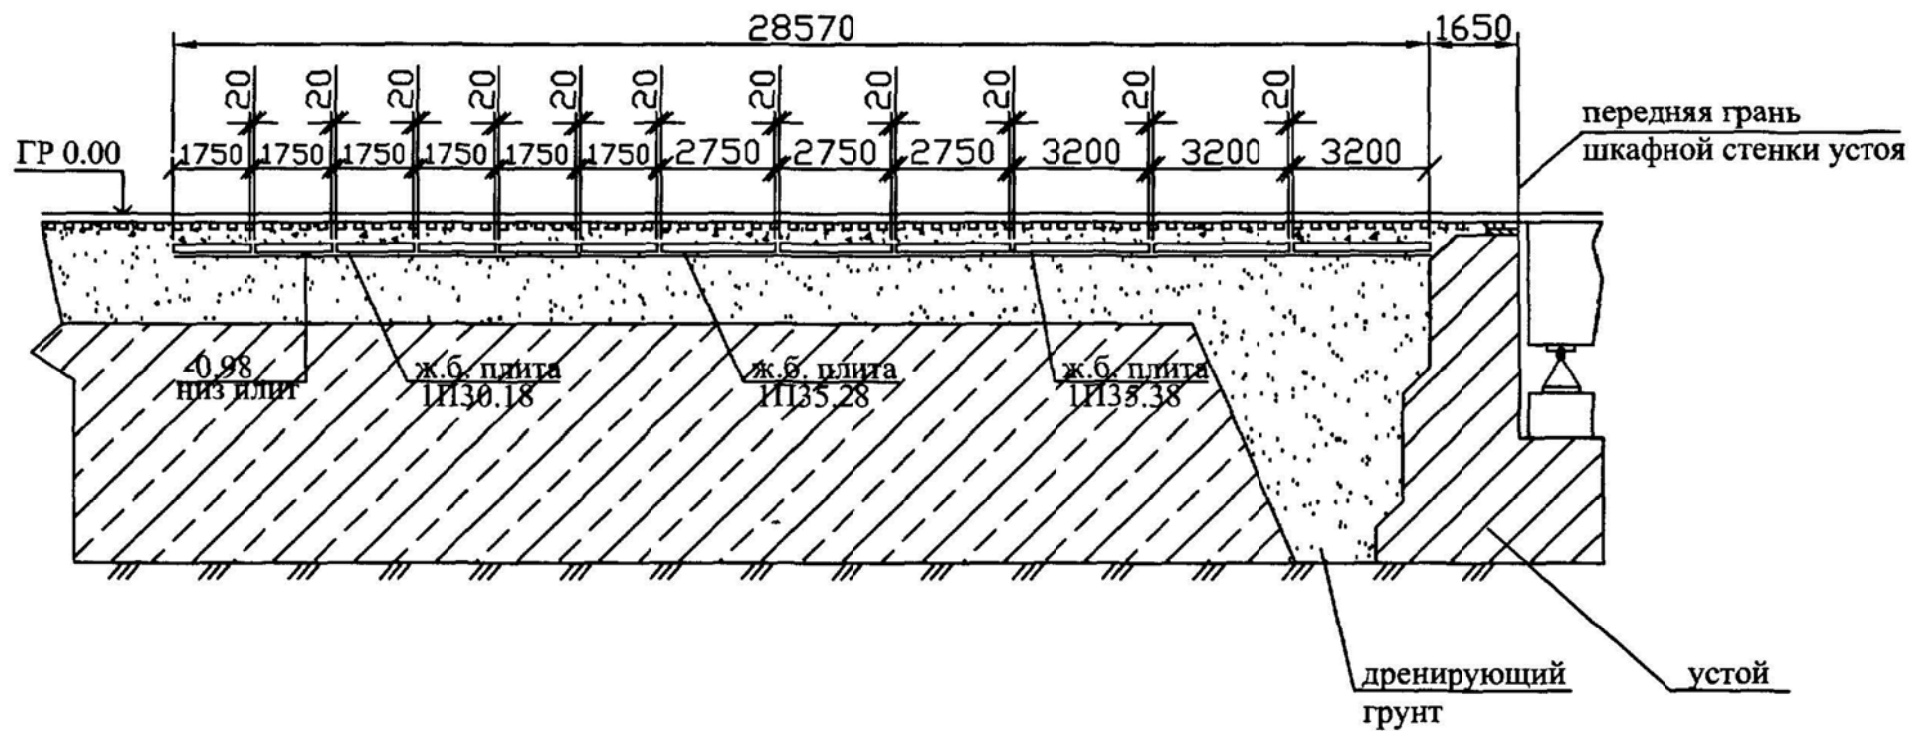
УПЖ из подбалластных железобетонных плит (продольный профиль)
